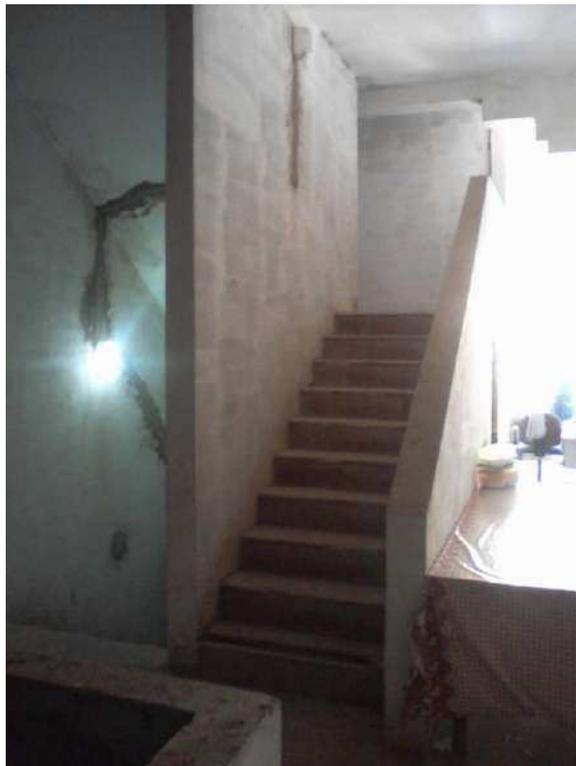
Rua Humberto de Campos, 107, escada de acesso ao pavimento superior
